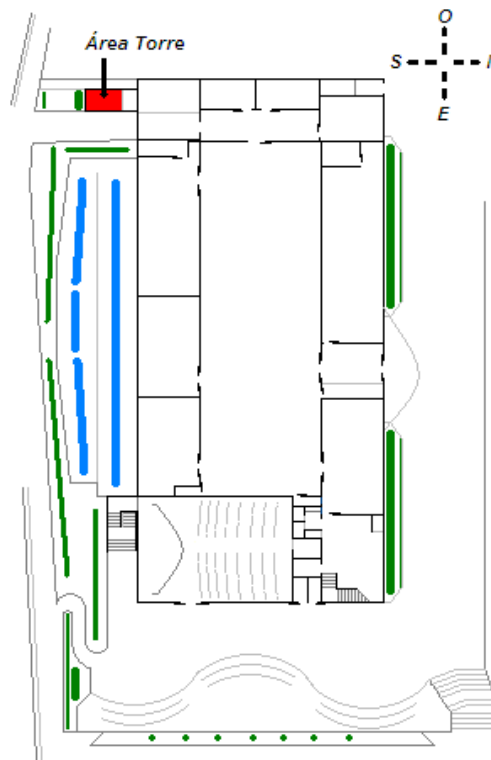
Plano de la ubicación de la torre de enfriamiento.
